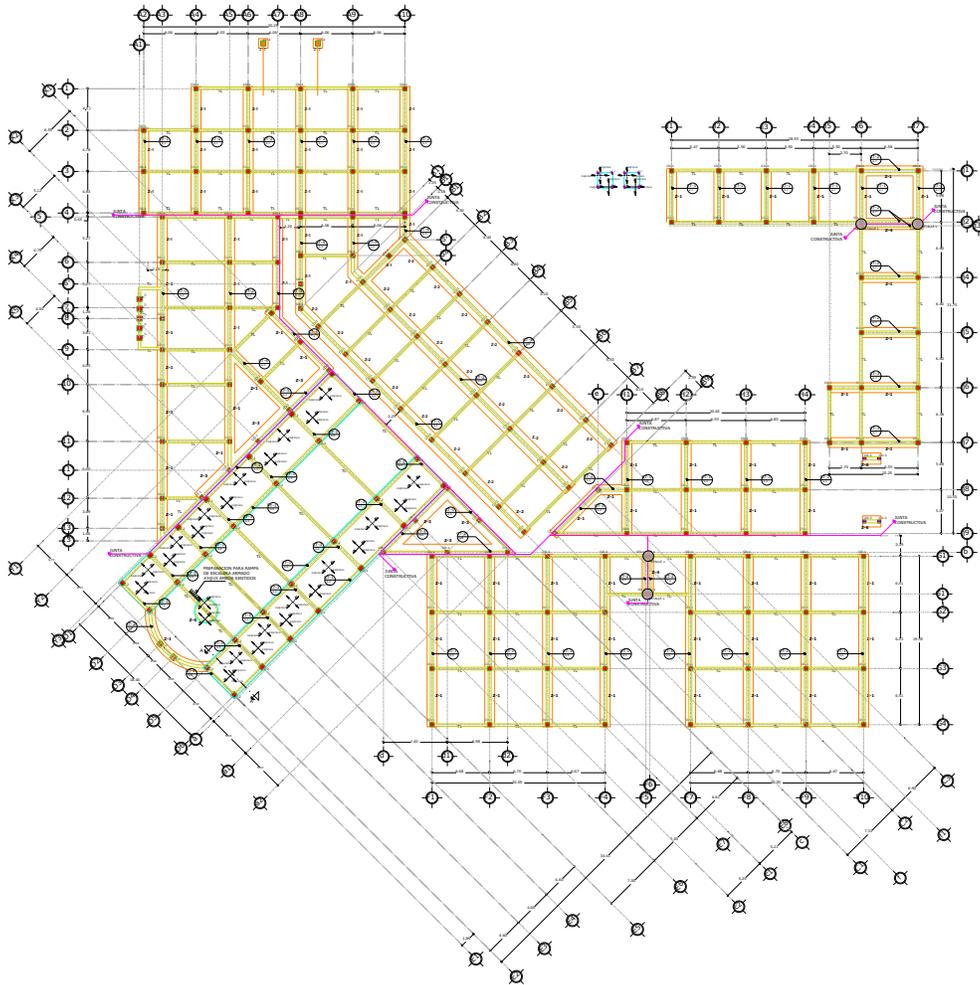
Planta Estructural de Cimentación de Conjunto.
